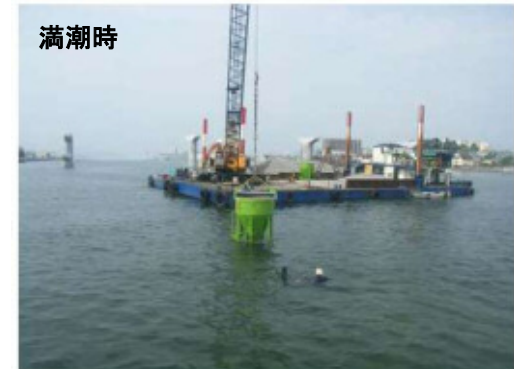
(1) 石炭灰造粒物層の構築方式での施工状況
